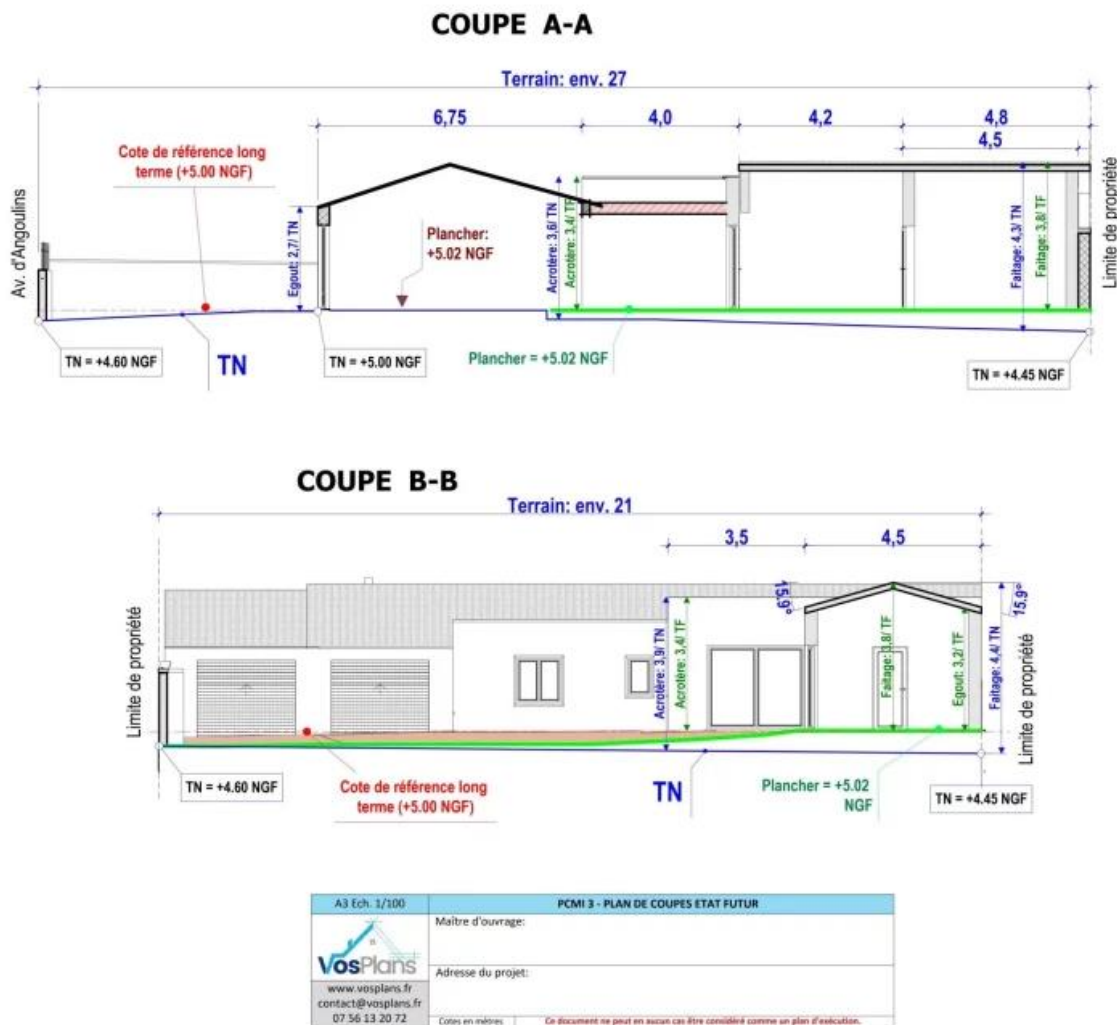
Exemple d'un plan de coupe (Vosplans, 2025)
